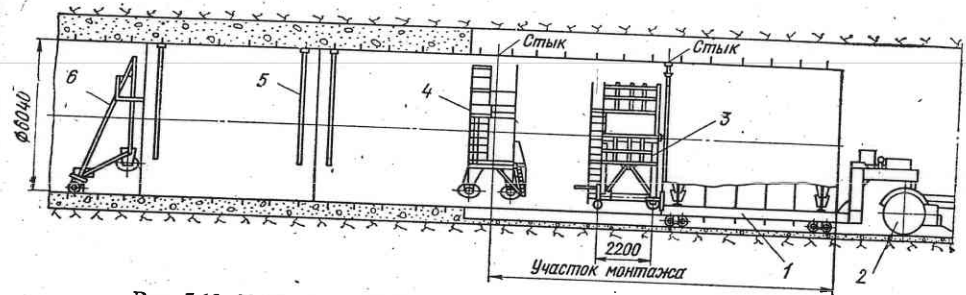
Монтаж трубопровода в туннеле на горизонтальном участке:
